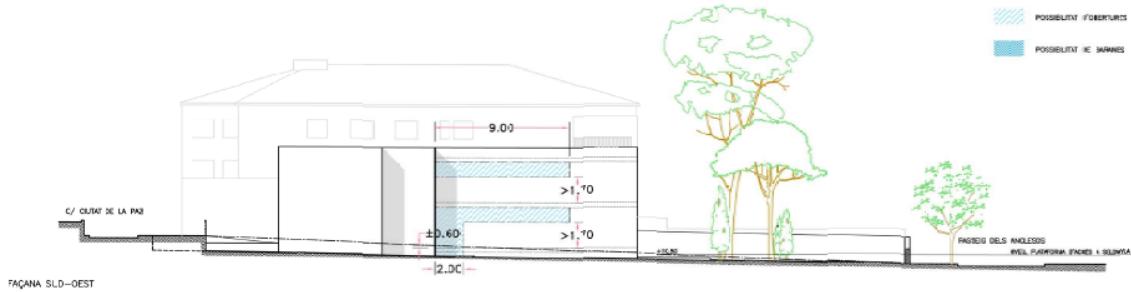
Proposta d'obertures a la façana sud-oest de la nova edificació
